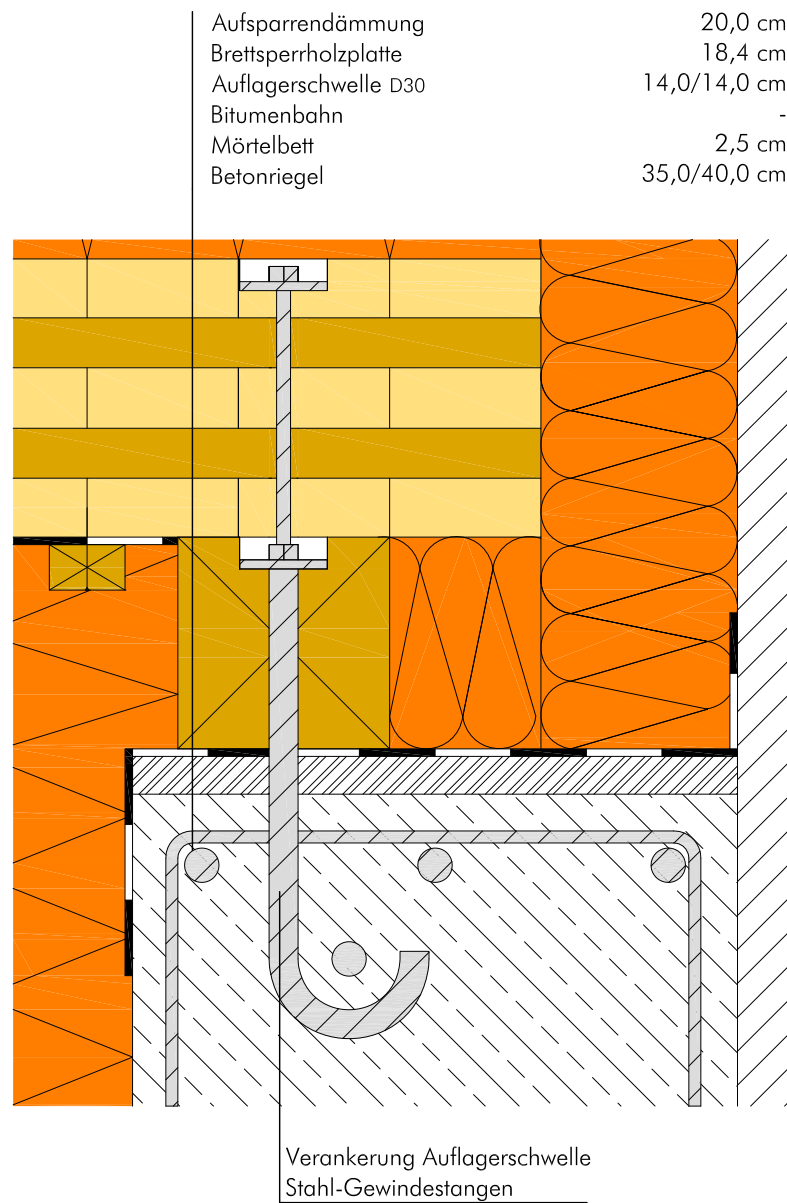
Detail B: Anschluss BSP-Platte – Auflagerschwelle – Betonriegel M 1:5
